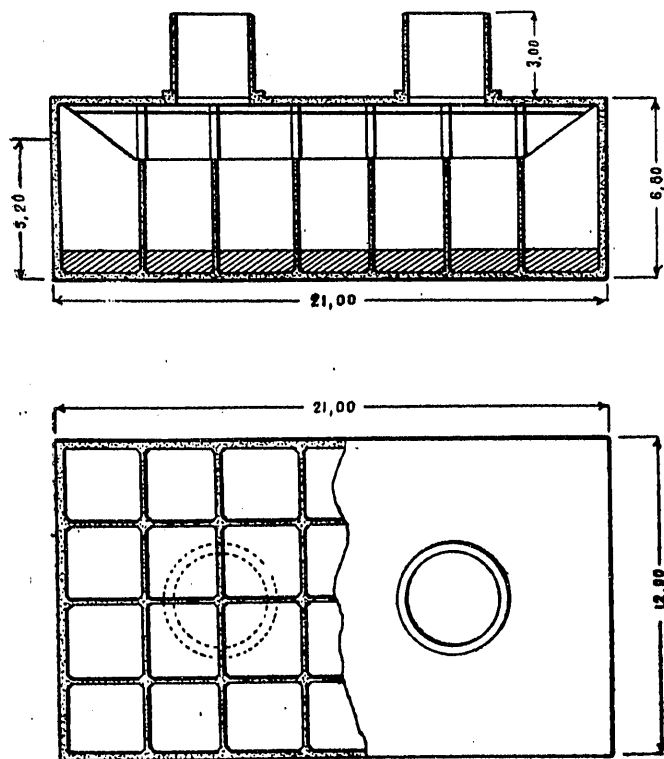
Corte longitudinal y planta de los cajones del puerto de Llanes
